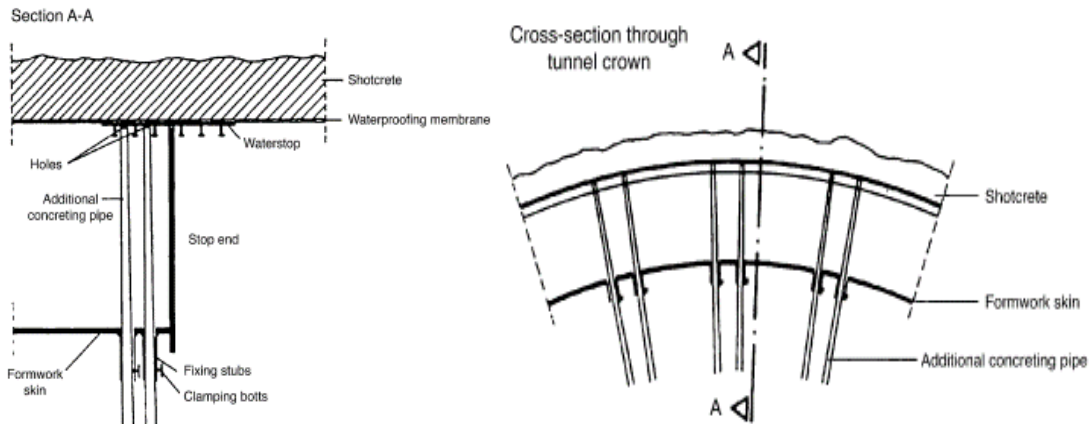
Instalación de tubos de hormigón en la zona de corona del túnel
